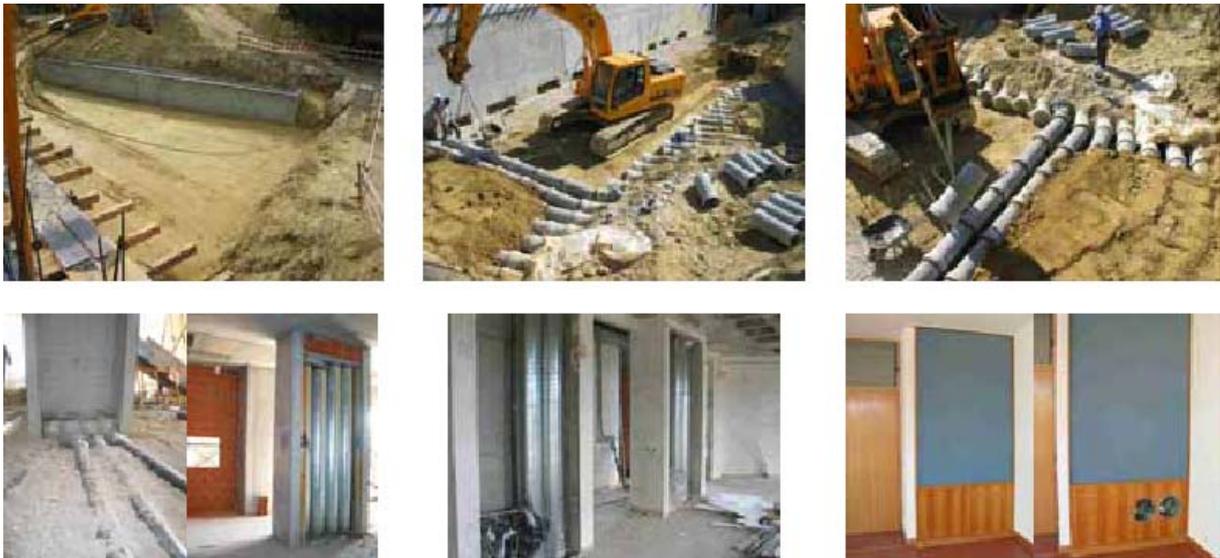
Fotos da construção e montagem dos tubos de arrefecimento
